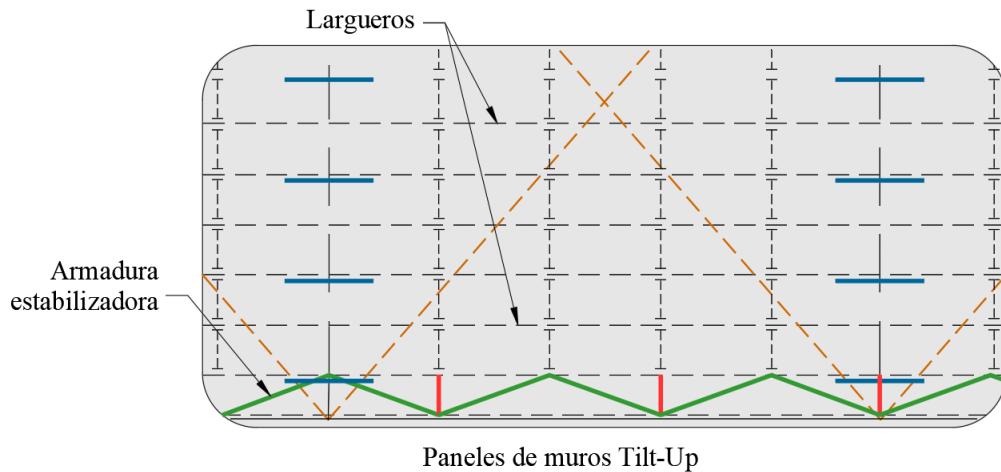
Armadura horizontal estabilizadora en la parte superior de los muros
